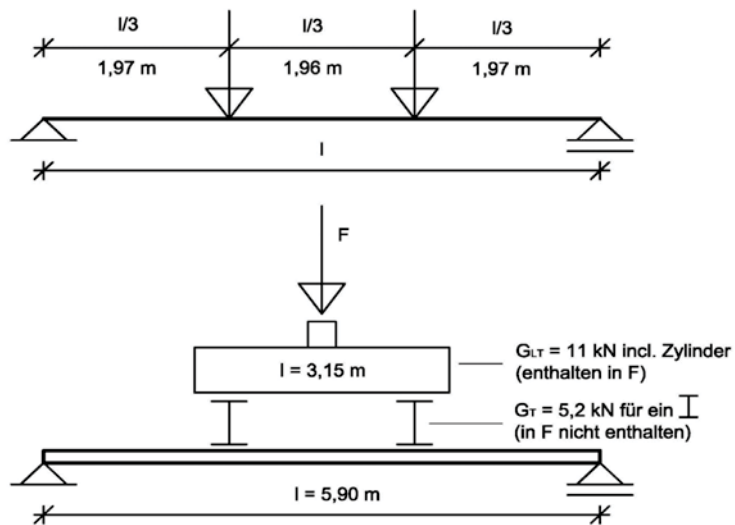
Belastungsanordnung und Einrichtung Spannbetondeckenplatte 22006
